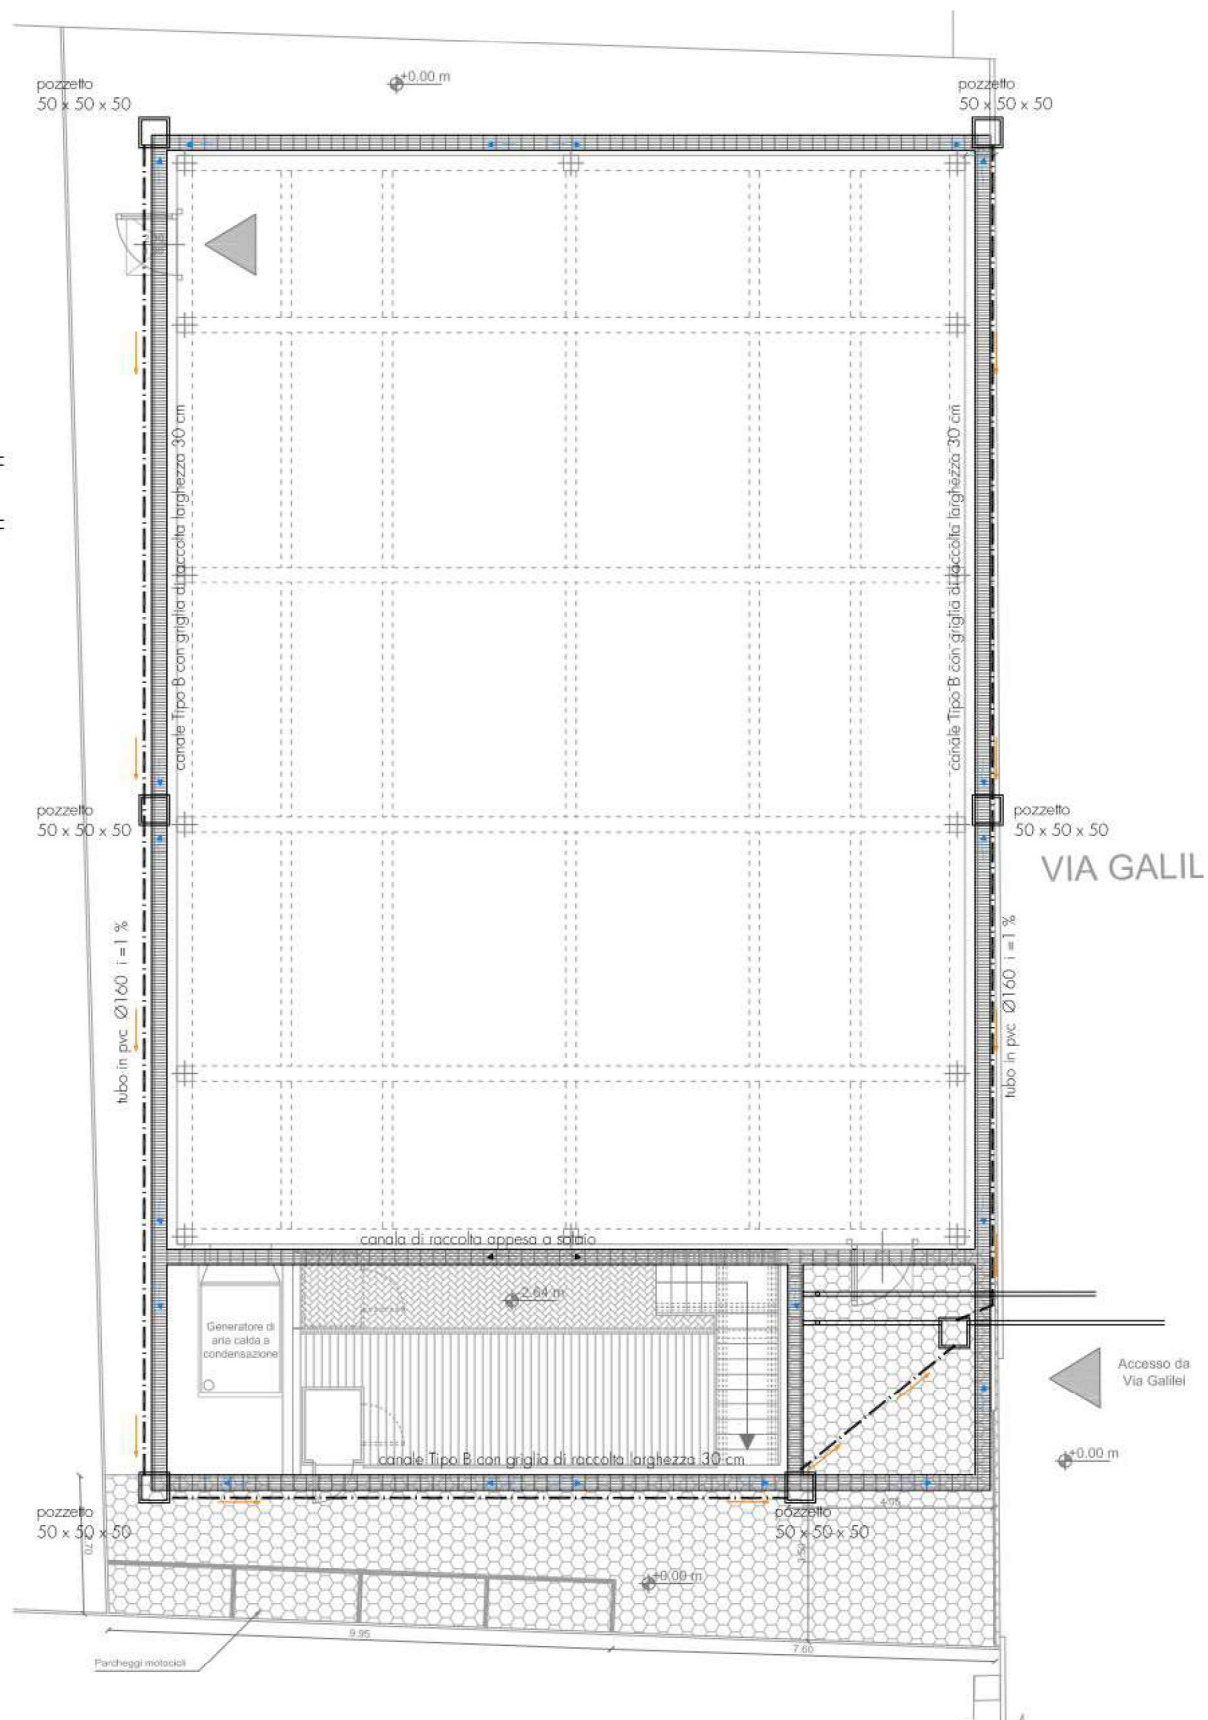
Planimetria sistemazione impianto acque meteoriche livello suolo
